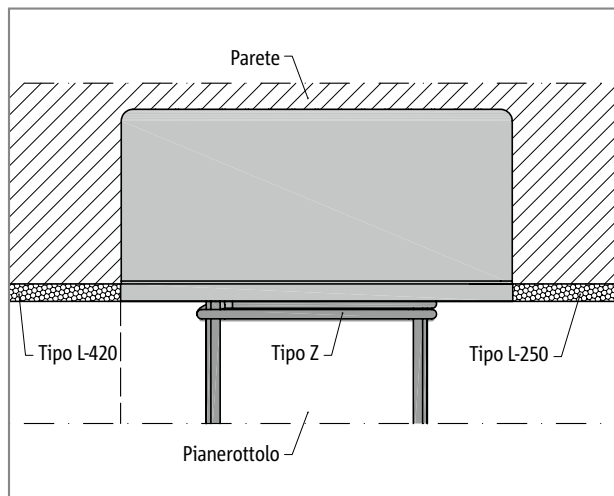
Schöck Tronsole® tipo Z, disposizione dell'elemento; dettaglio A
